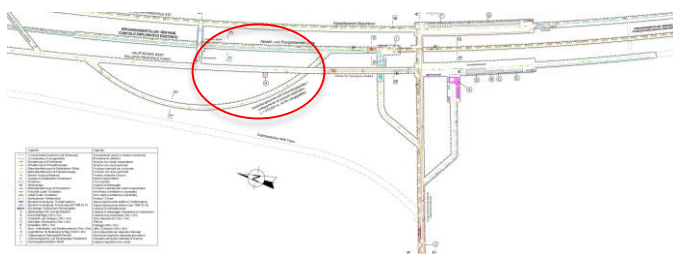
geschützte Lagerfläche am nordöstlichen Tunnel
